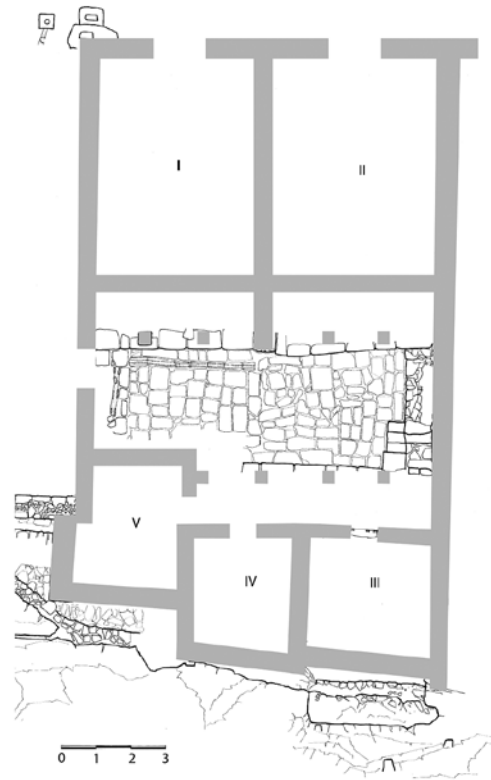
Parzelle E5. Grundriss vor der Aufgabe des Gebäudes
